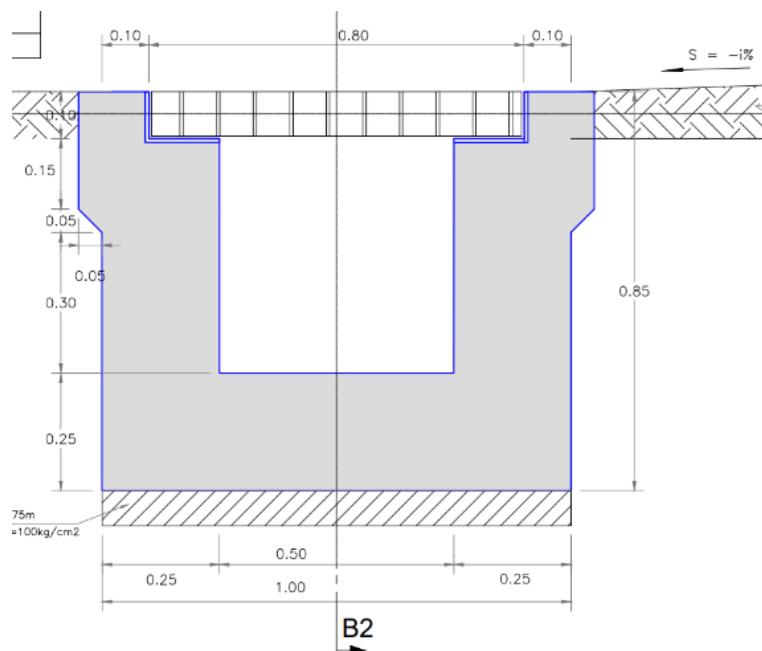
Detalle de canal rectangular TIPO II con Rejilla
